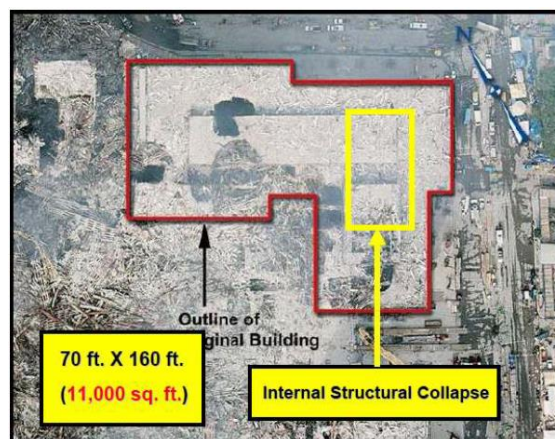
Localização em planta da zona do WTC 5 onde se deu o colapso. [48]
